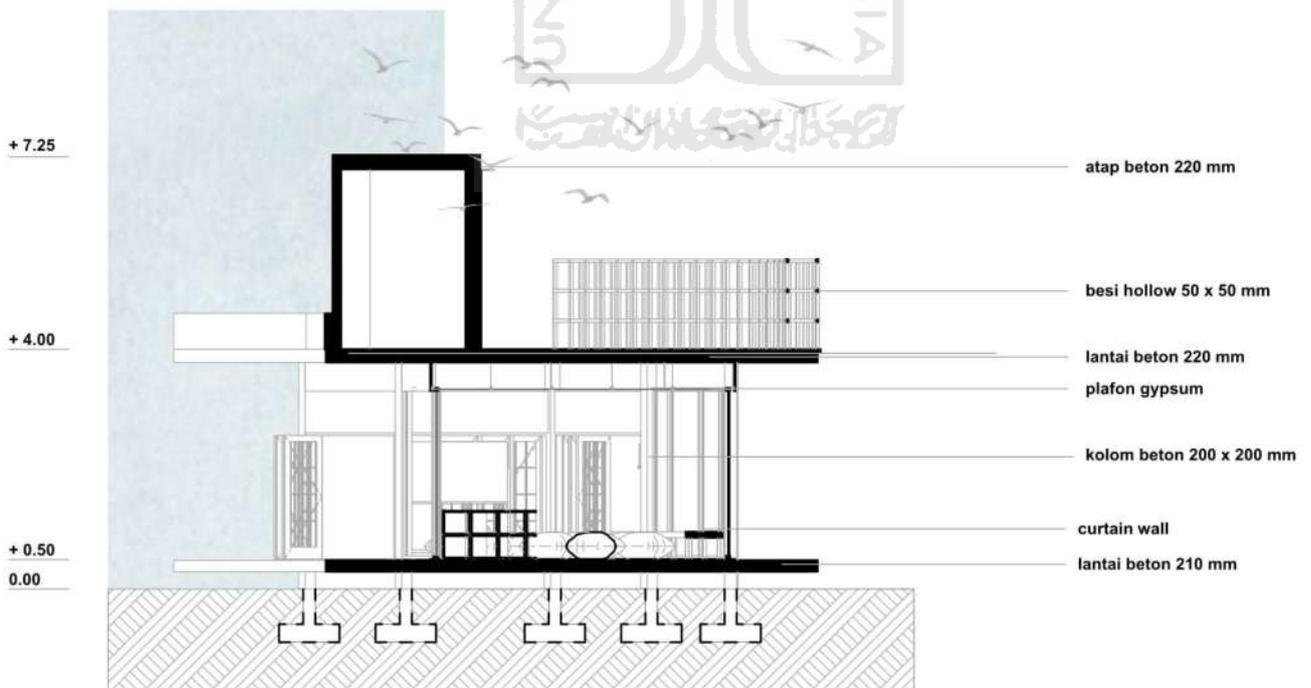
Perpustakaan Bangunan Perpustakaan
